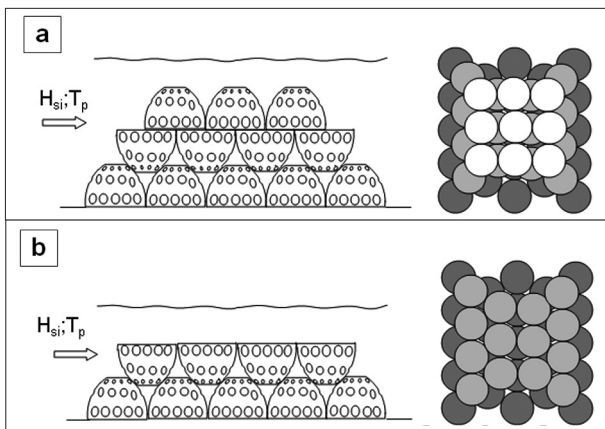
(a) BS-3 in sezione (sx) ed in pianta (dx); (b) BS-2 in sezione (sx) ed in pianta (dx).
